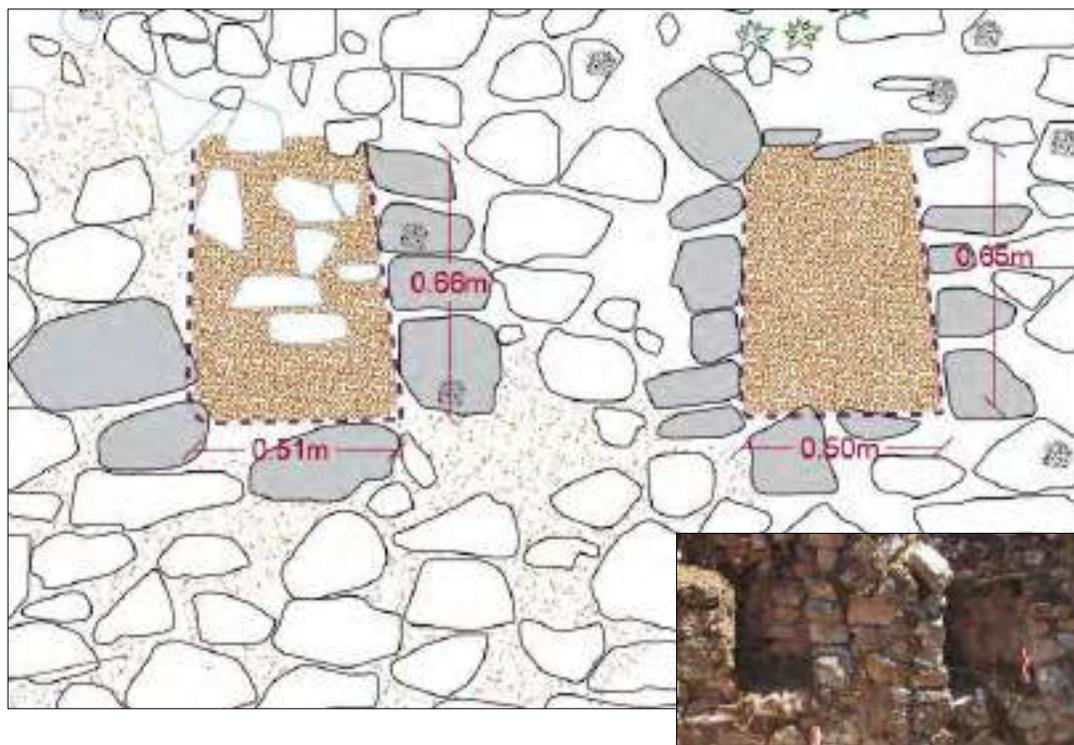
Nichos de forma trapezoidal en la Estructura - 01A
